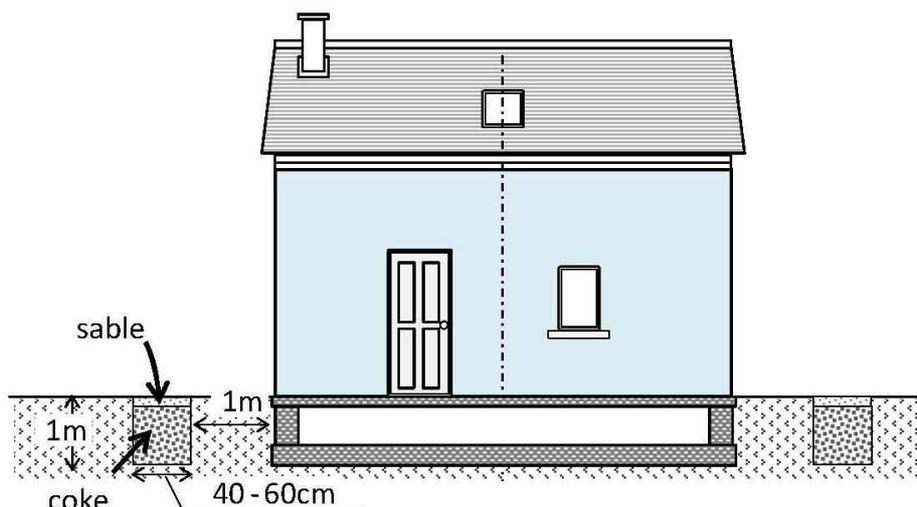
Exemple de tranchée compressible périphérique à l'aide de remplissage de type coke
